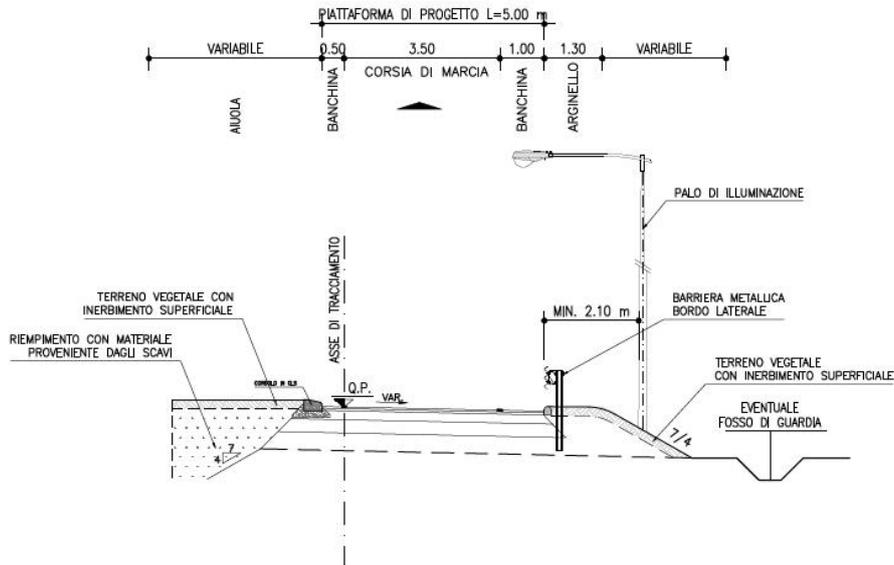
Sezione tipo ramo di ingresso in rotonda, singola corsia
